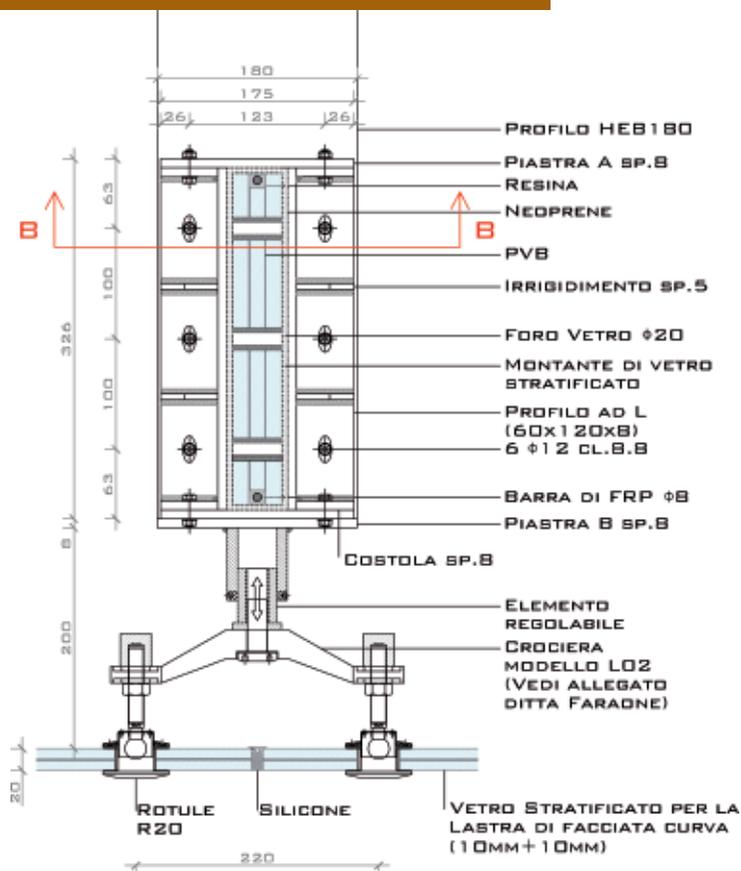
Prospetto particolare A - Collegamento tra i montanti e le lastre di facciata
